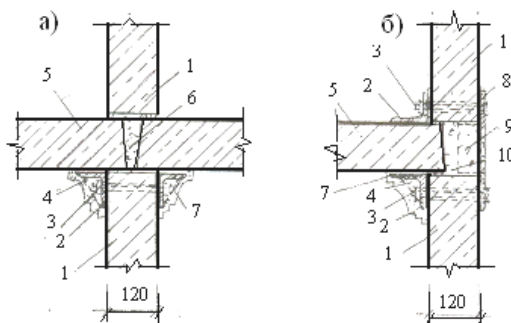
Усиление узлов сопряжения панелей стен с панелями перекрытий:
